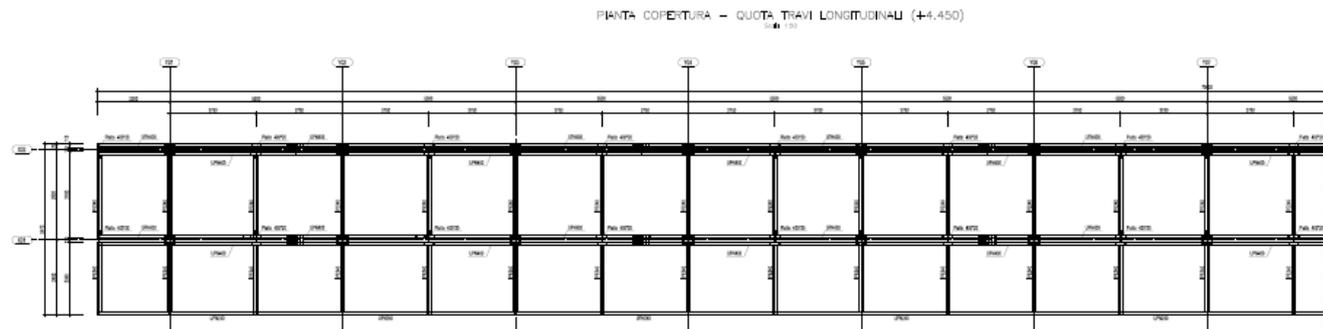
Pensiline – Stralcio Pianta Copertura quota +4.450 - Pensilina Sud
